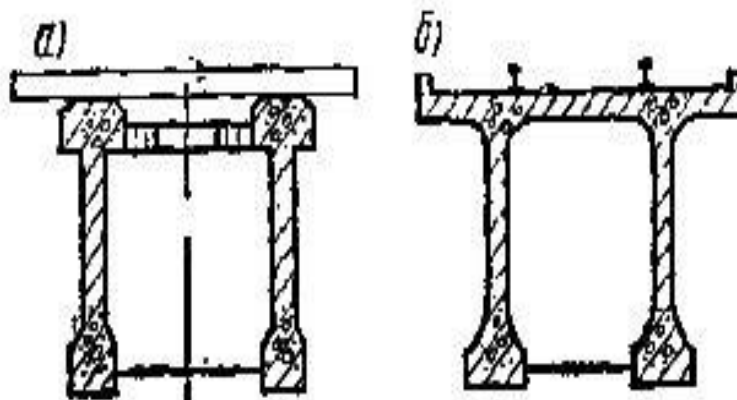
Поперечное сечение безбалластных пролетных строений под железную дорогу:
